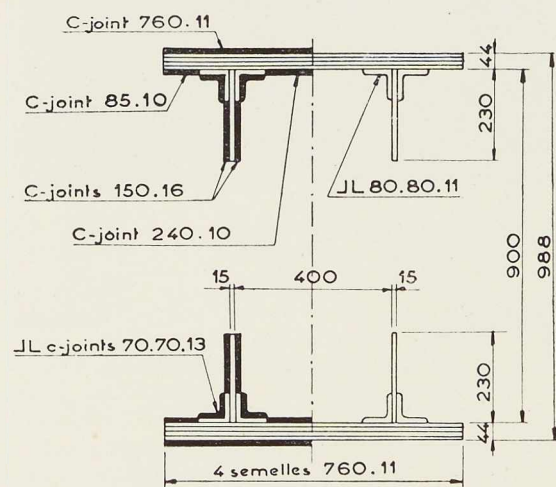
Section transversale dans un arc de l'arche centrale au droit d'un joint (à gauche) et hors d'un joint (à droite). (Couvre-joints en noir.)
